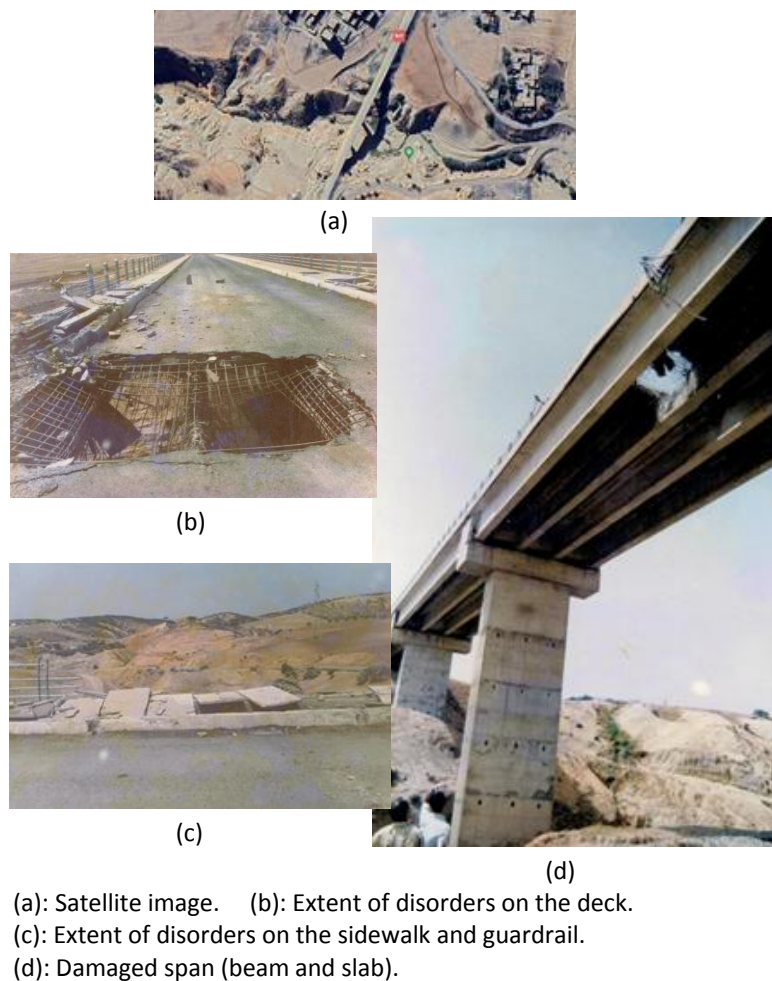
Pont sur Oued Gouasmia RN 17 (Source Auteur)
